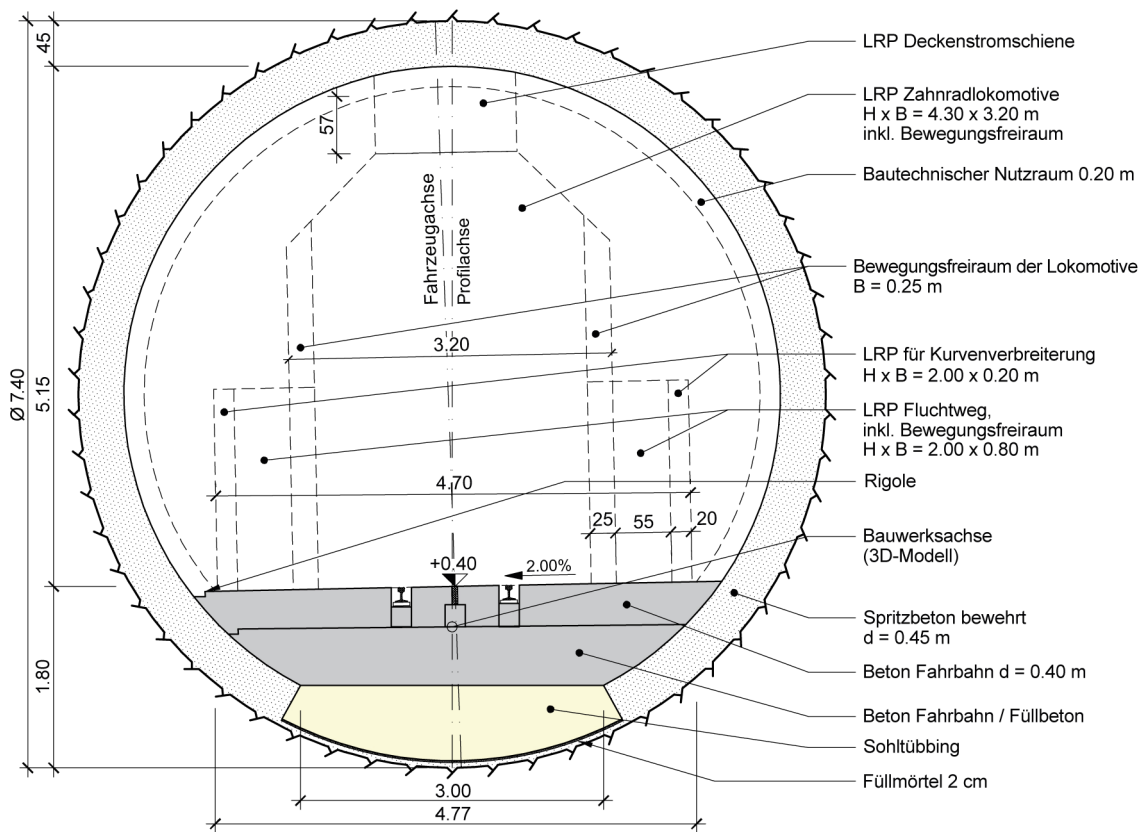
Stichtunnelprofil A50 des Zugangstunnels JO im Bereich Abzweiger (Nicht massstäblich.)
